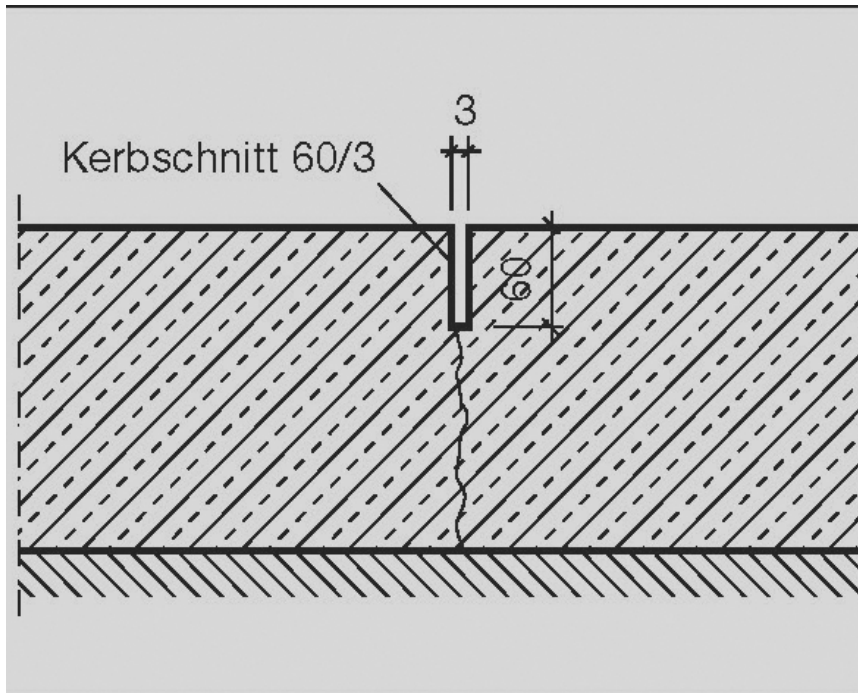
Querscheinfuge in Fahrbahndecken aus Beton
